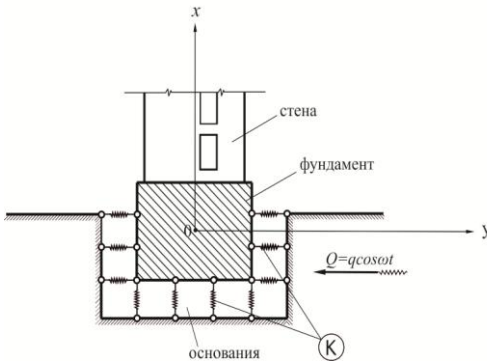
Расчетная схема для определения горизонтальной составляющей нагрузки на здание от колебания фундамента
